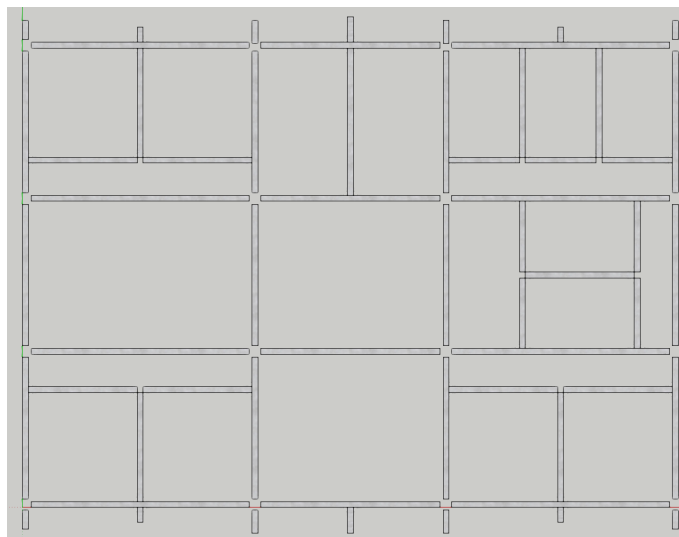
15 denah Lt 1 bangunan kampus Stital.
